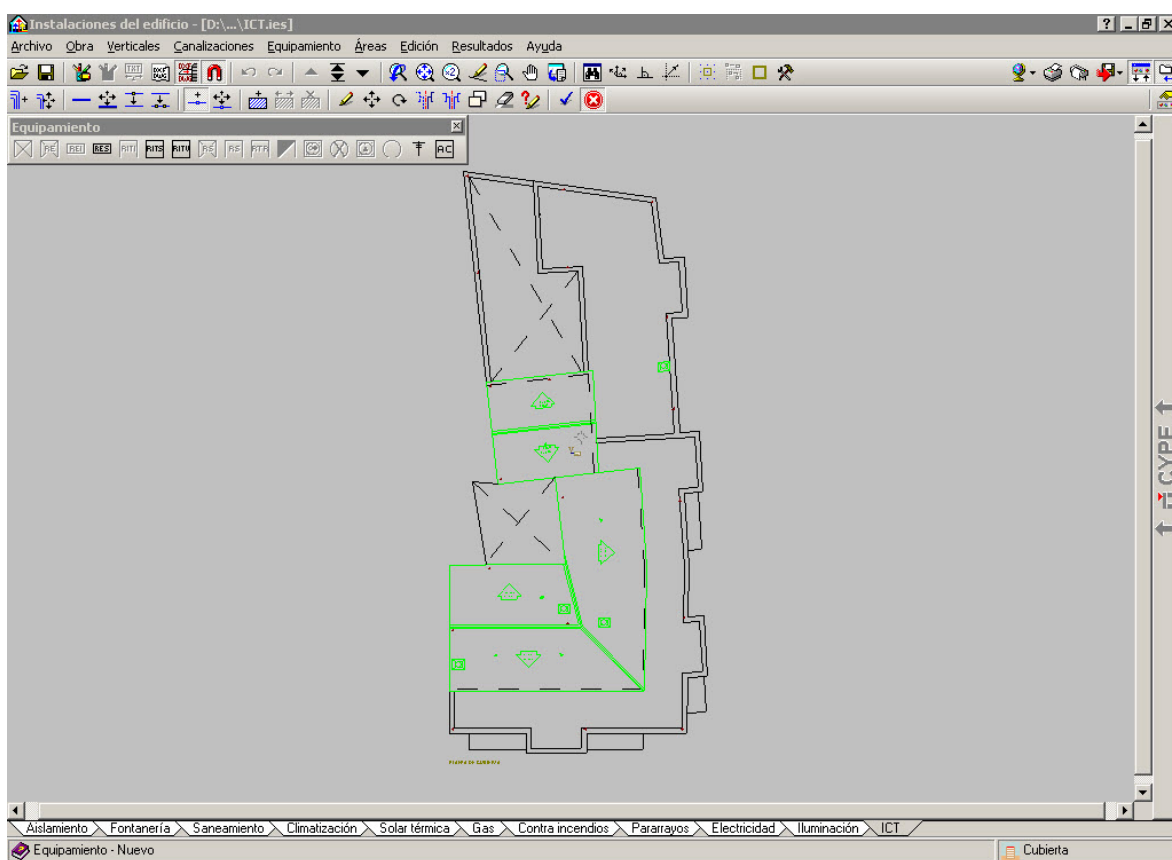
Instalación ICT planta cubierta (pre-dimensionado)
